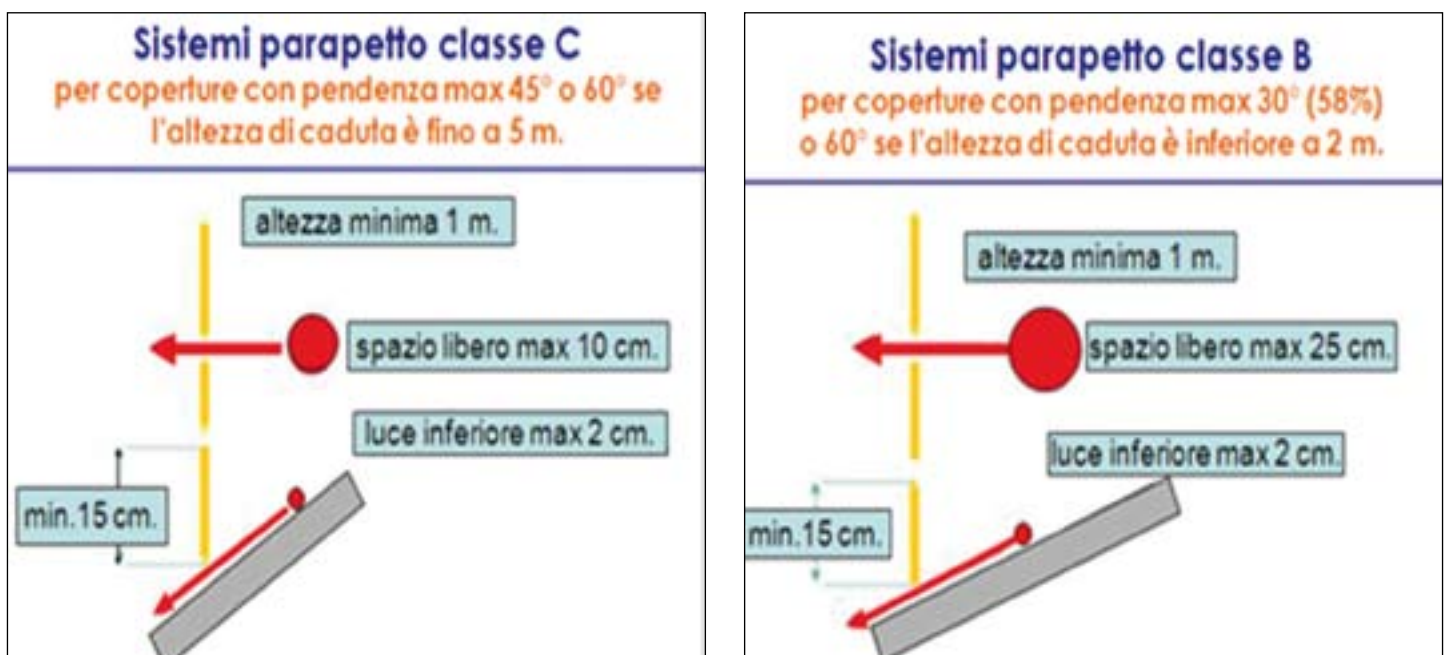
Sistemi parapetto per protezione su piani inclinati secondo la norma armonizzata UNI EN 13374.
